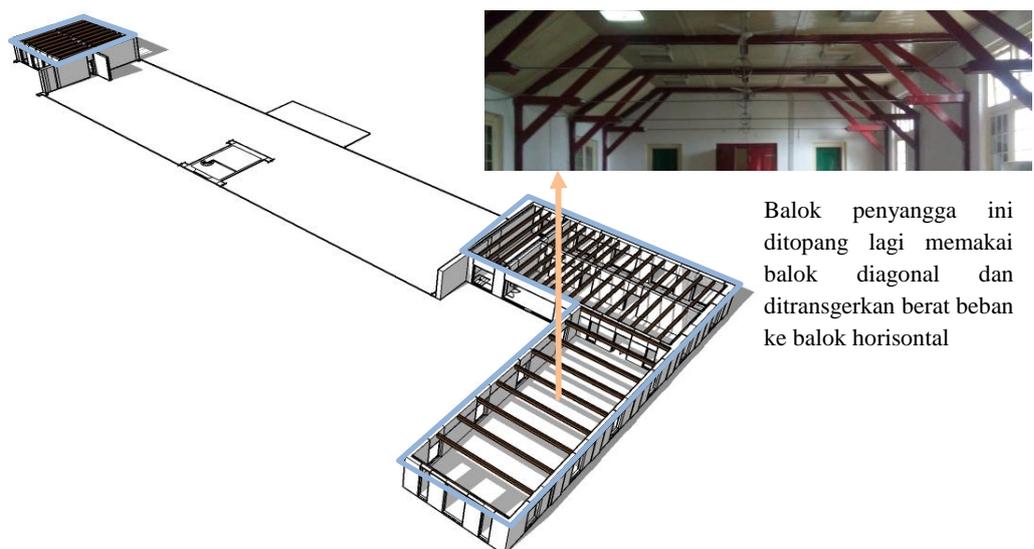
Struktur Balok penyangga lantai 1 bangunan Museum Fatahillah
